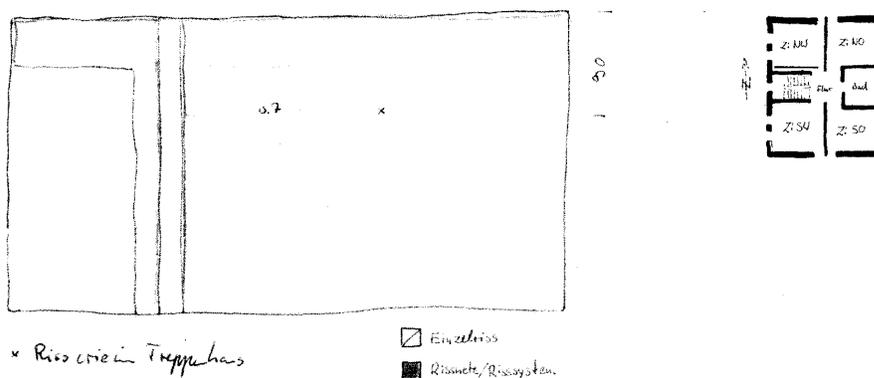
Obergeschoss, Kinderzimmer Nordwest, Risskartierung der Wand zum Treppenhaus
